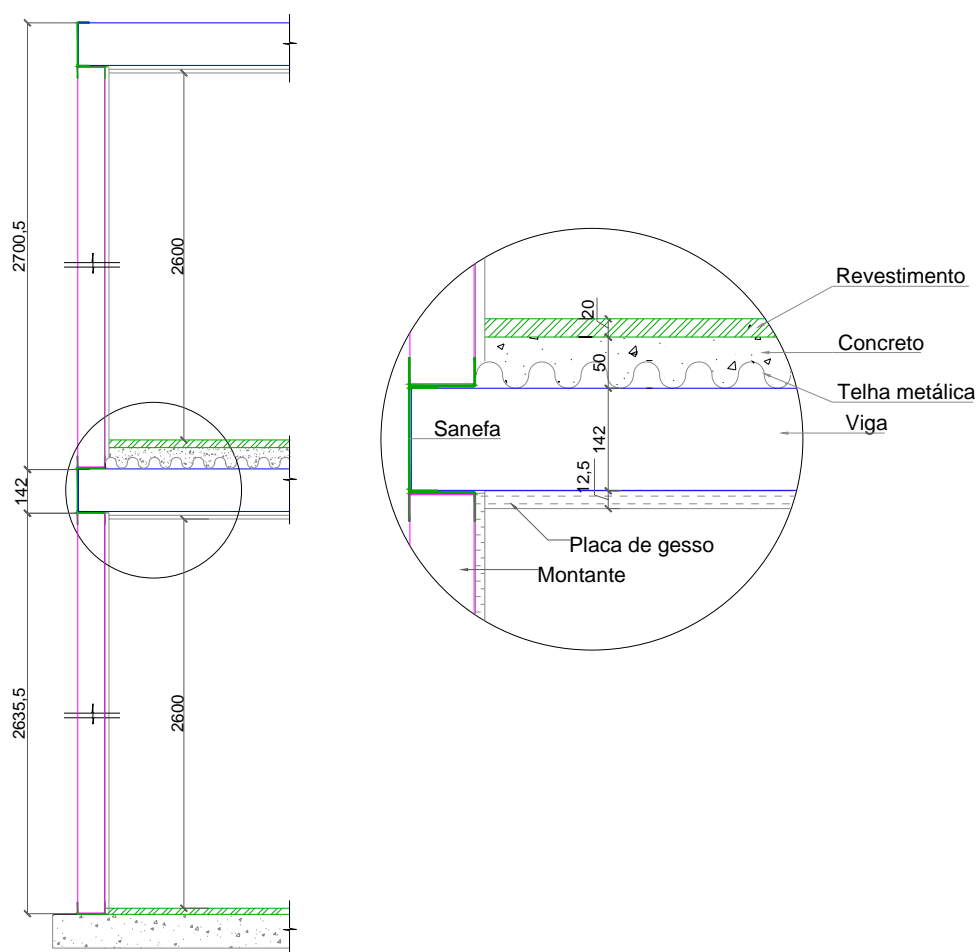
Configuração de piso úmido utilizada para os modelos de 4 pavimentos.
